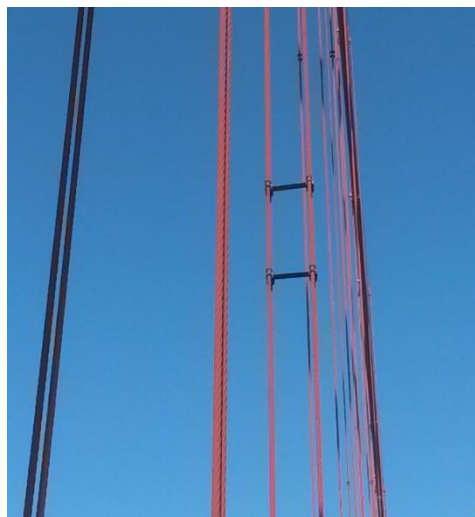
Utilização de braçadeira para impedir a vibração excessiva.
